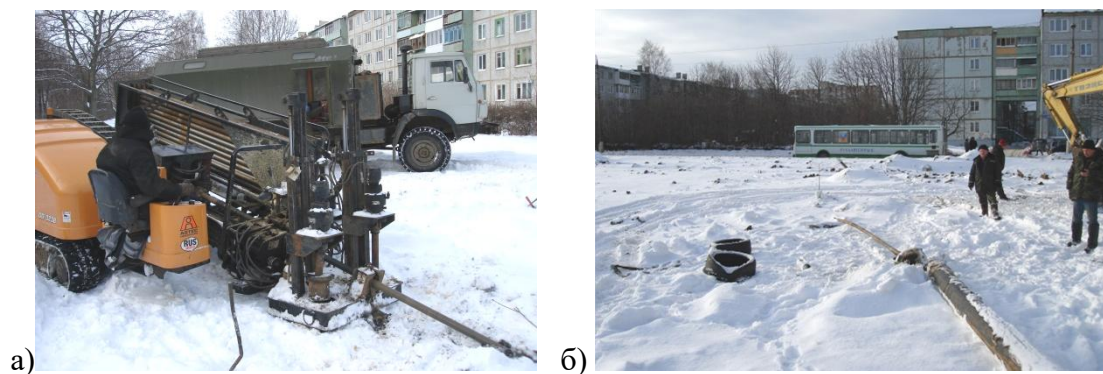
Общий вид предлагаемой грунтопрокалывающей установки
